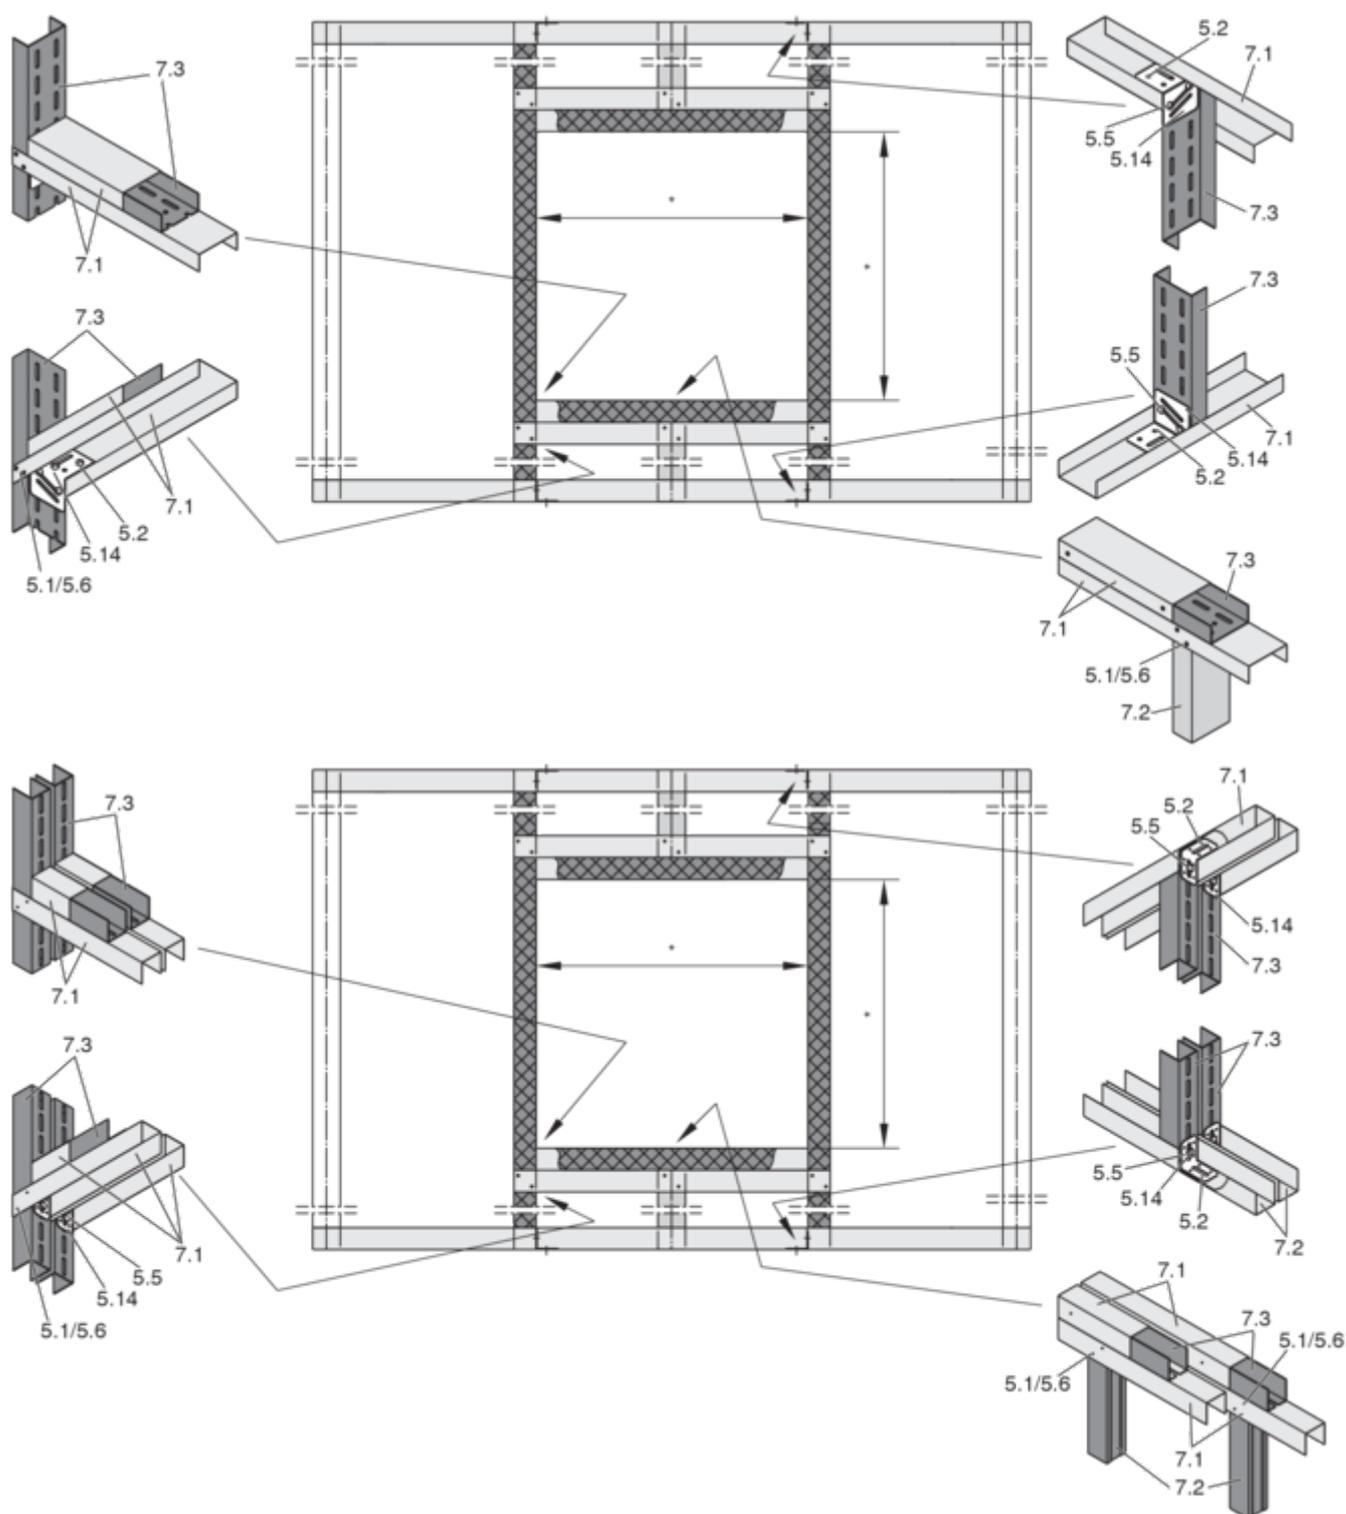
Estrutura de apoio de metal para uma parede de compartimento, sistema de cavilha simples e sistema de cavilha dupla
